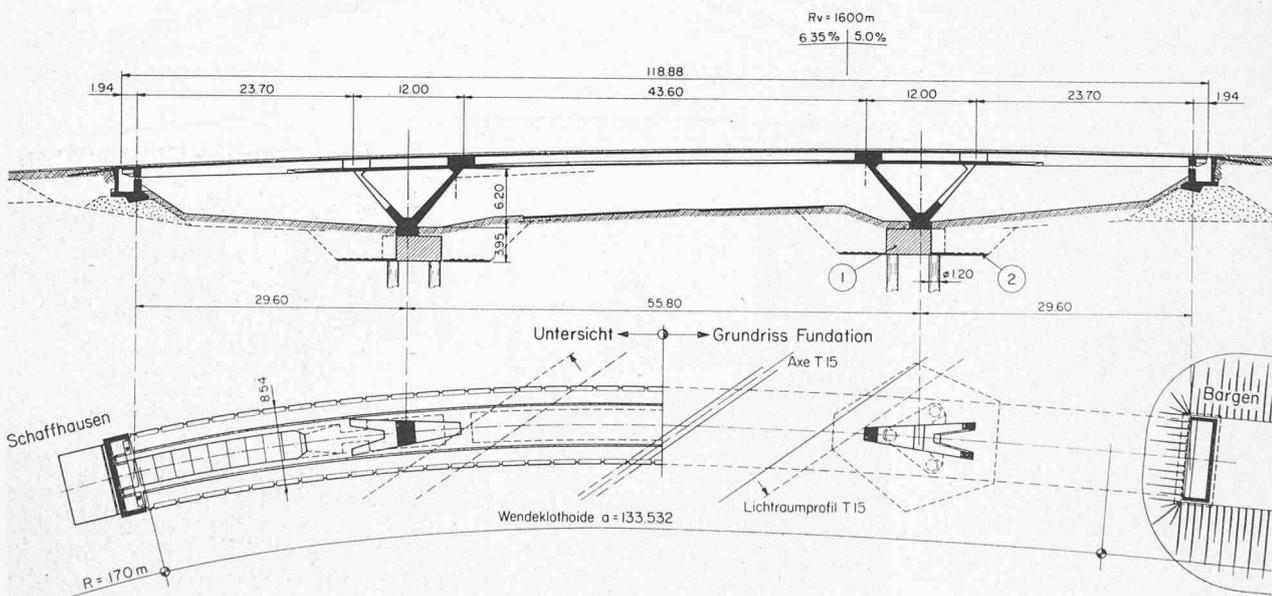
Längsschnitt und Grundriss: 1 Pfahlbankett, 2 Reibungs-Verankerungplatte
